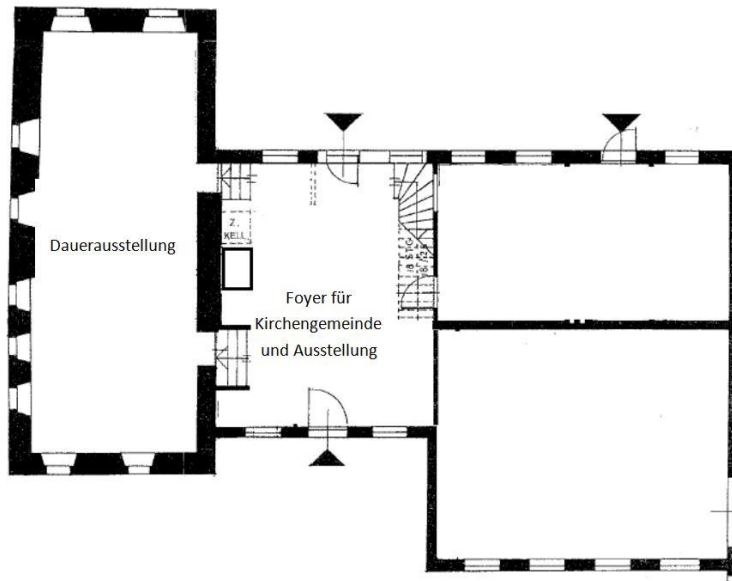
; Grundriss des Gebäudes im EG
